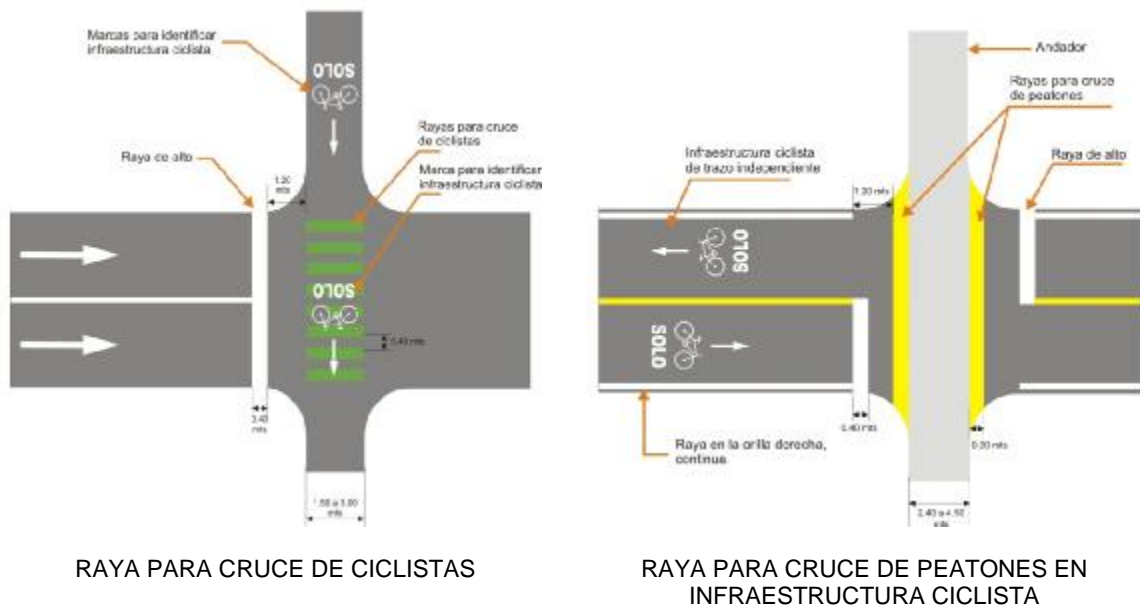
Señalización horizontal en pavimento de Infraestructura Ciclista
